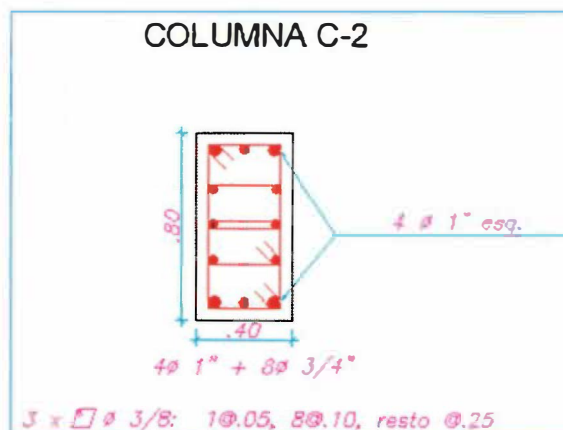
a: Configuración final de refuerzo en columna C-2 del 1er al 3er piso
